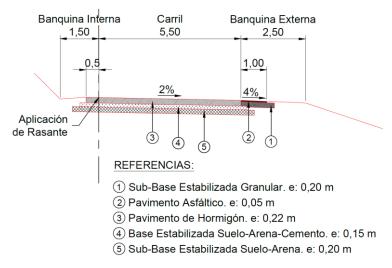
Perfil tipo ramales de 5,50 metros de ancho.
